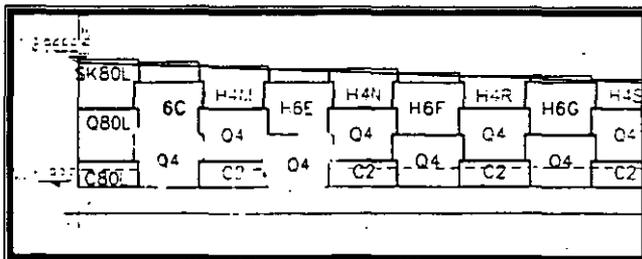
b. Perfil del muro de tierra armada. Llegada de muro a estribo.
